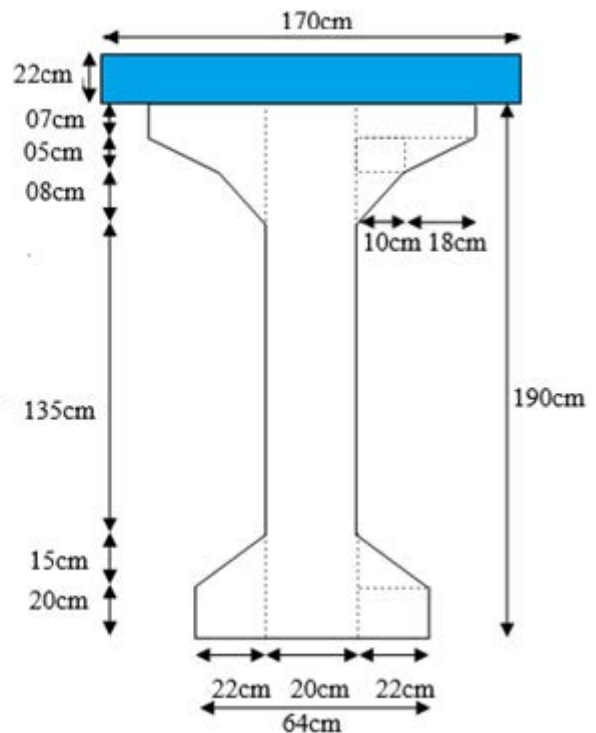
Section de la poutre intermédiaire avec hourdis.
